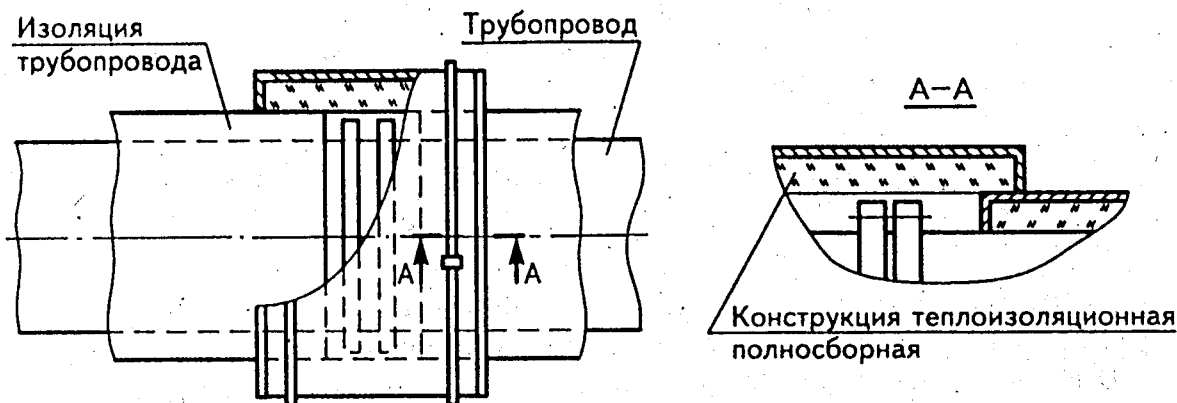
Тепловая изоляция фланцевого соединения конструкцией теплоизоляционной полносборной с теплоизоляционным слоем из цилиндров
